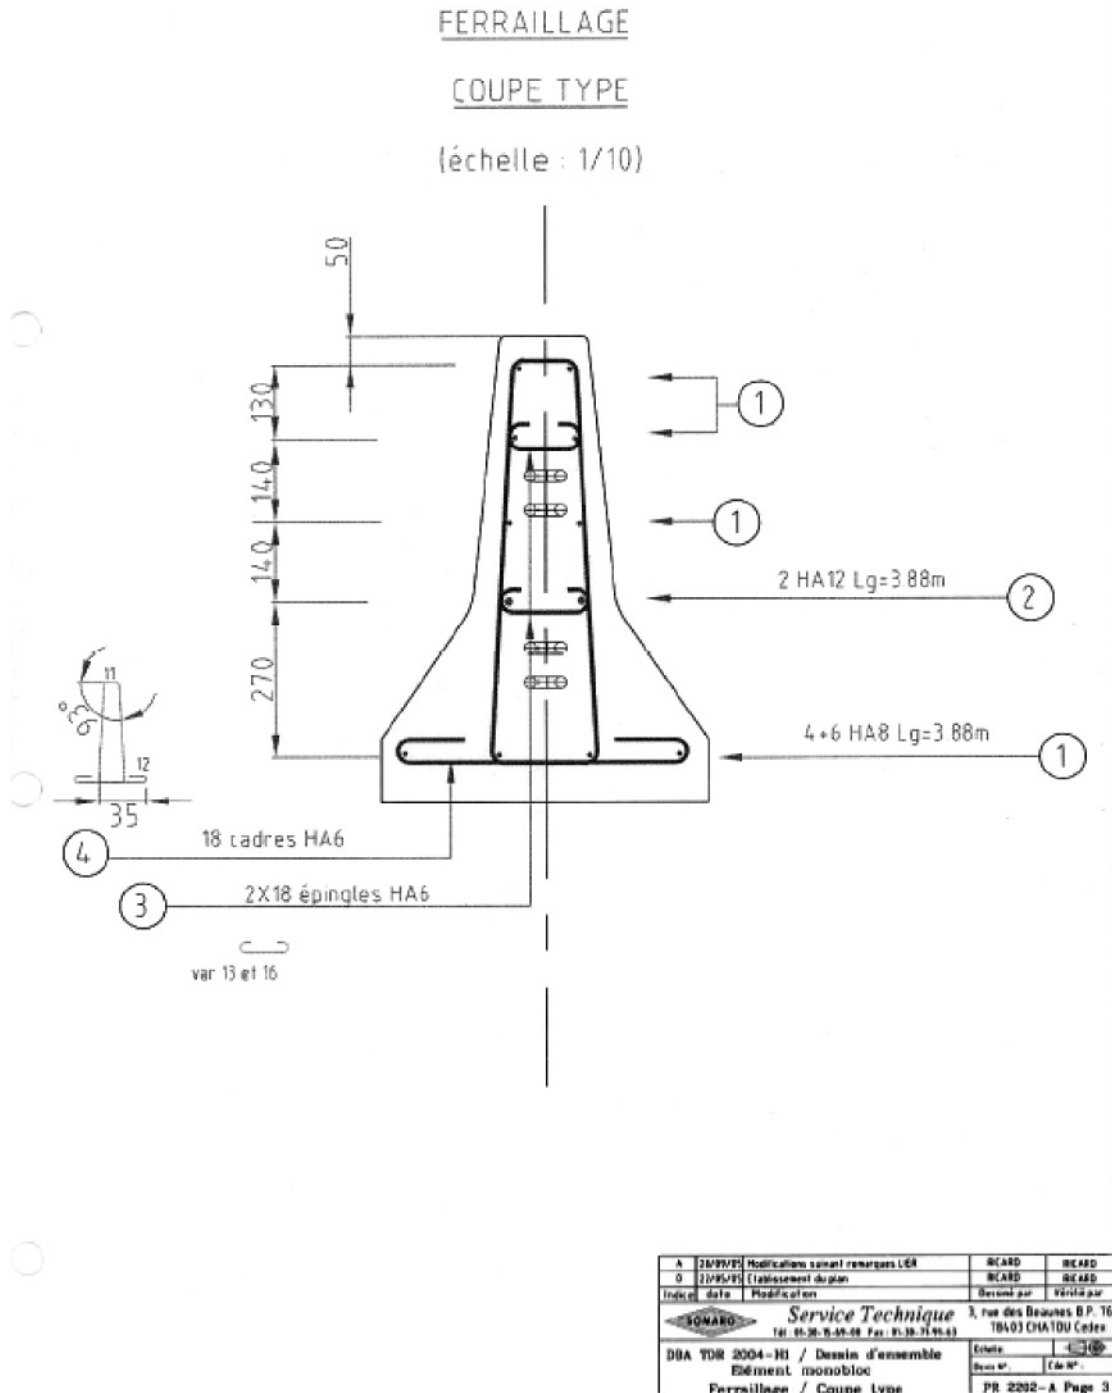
PR. 2202-A, page 3 : élément monobloc/ferrailage en coupe type
